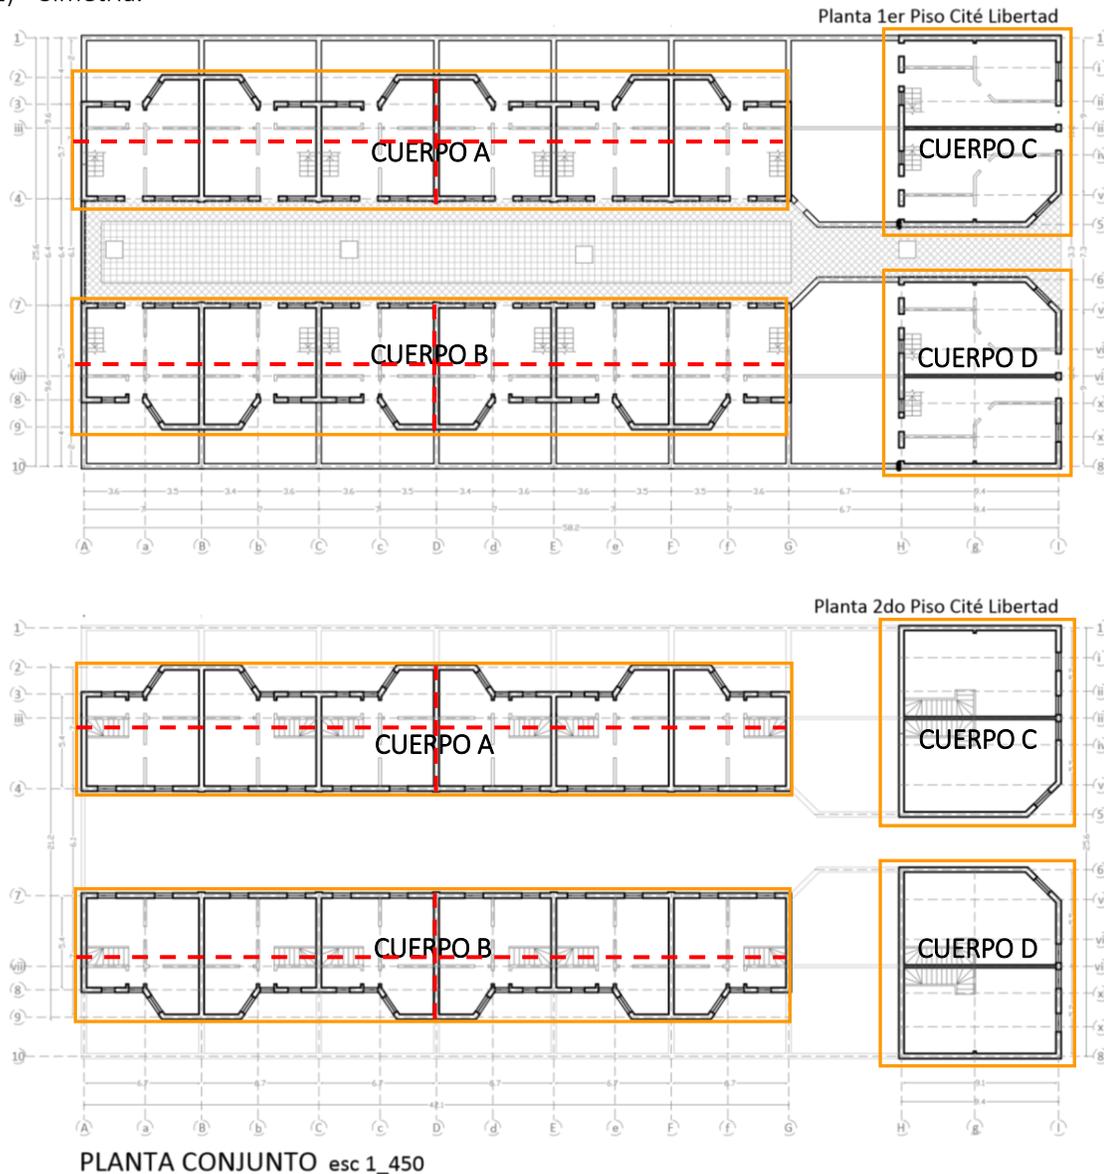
Planta Conjunto ESTRUCTURA Eje ROJO: Ejes de simetría horizontal y vertical (Cuerpos A-B, Cité propiamente tal).
